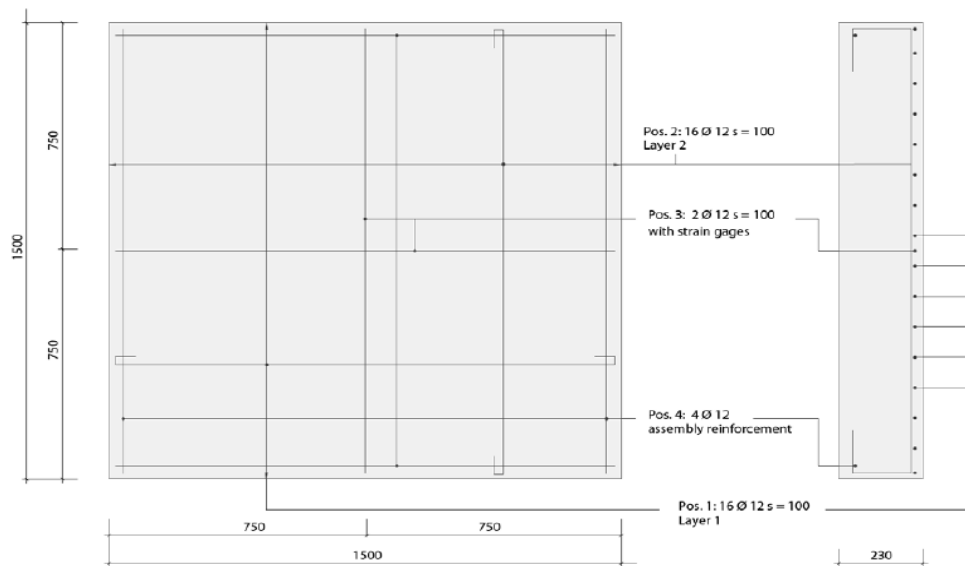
Схема армирования плит (все размеры указаны в мм) [23]
